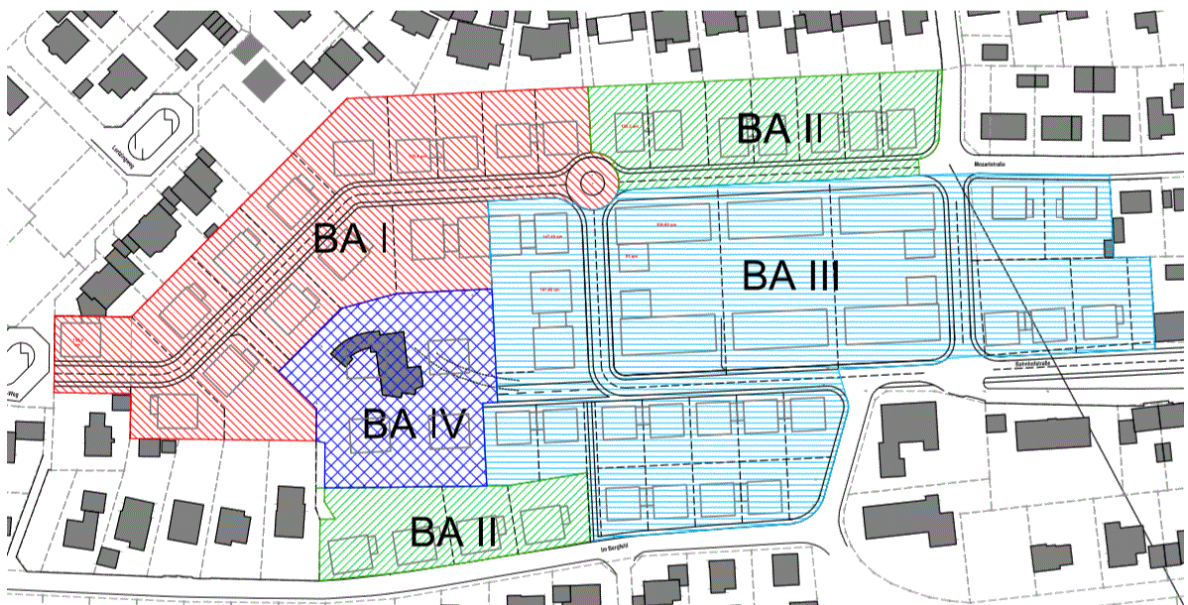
Geplante Bauabschnitte (Quelle: Gerst Ingenieure 09/2019)
